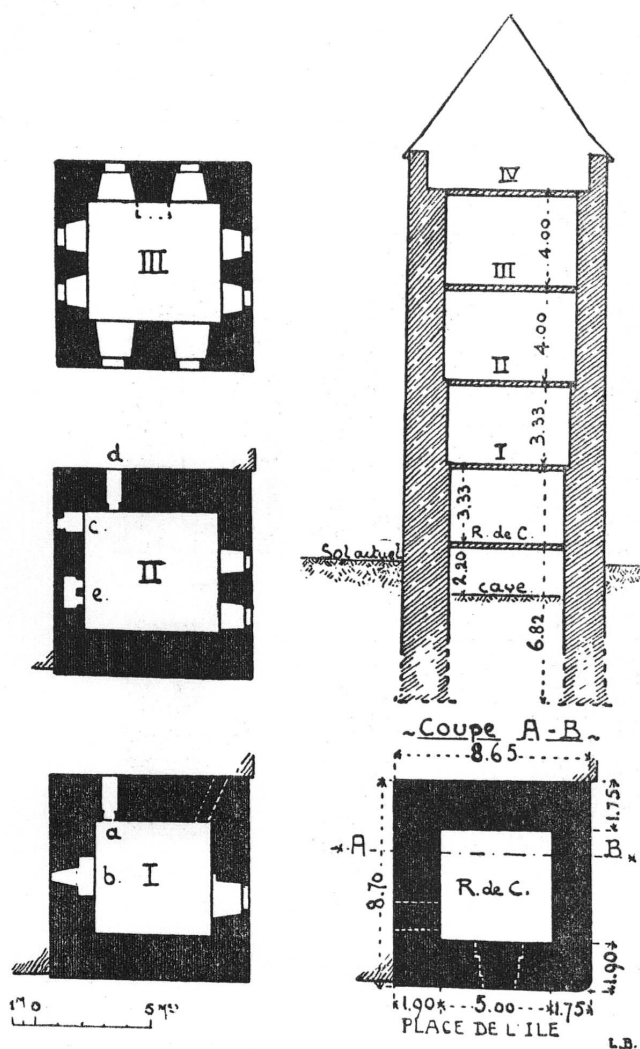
Plans des étages et coupe de la Tour de l'Île.
